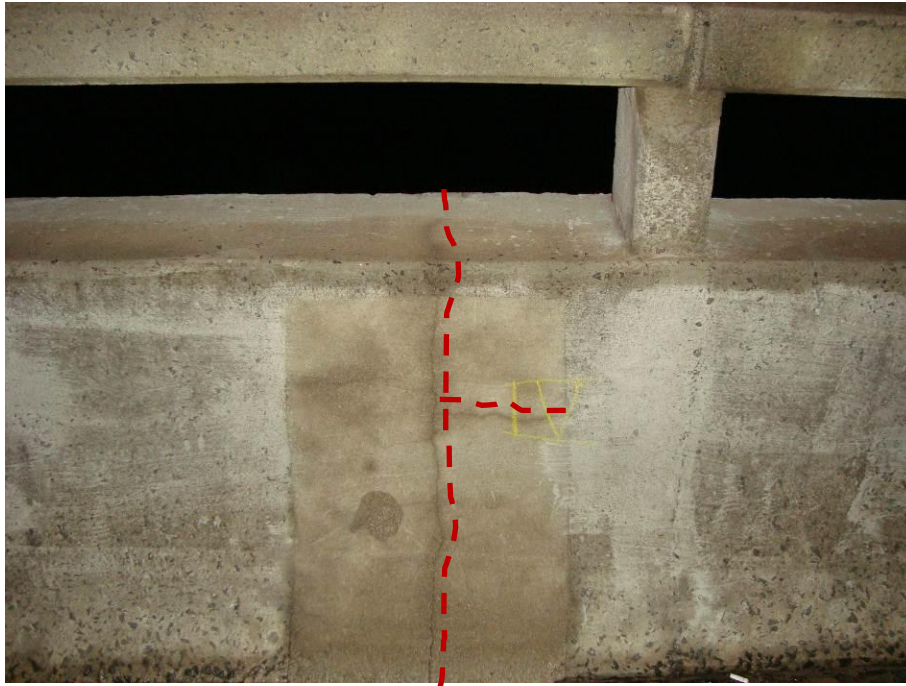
Local escolhido para o ensaio IV, sobre fissura e reparo executado anteriormente (aproximadamente 5 anos).
